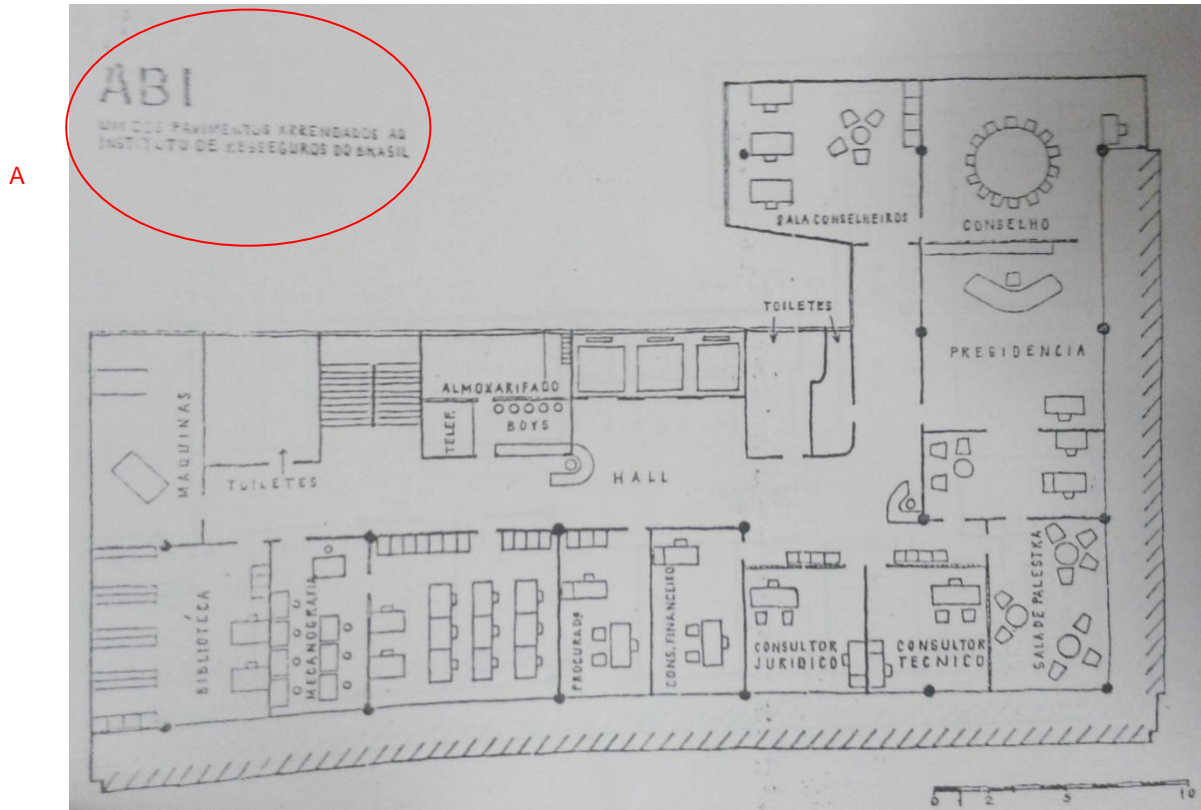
Planta do pavimento térreo (ou primeiro pavimento).
